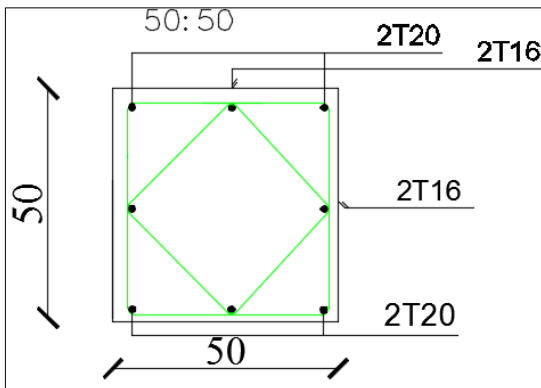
Ferrailage du poteau 1 (50× 50)
